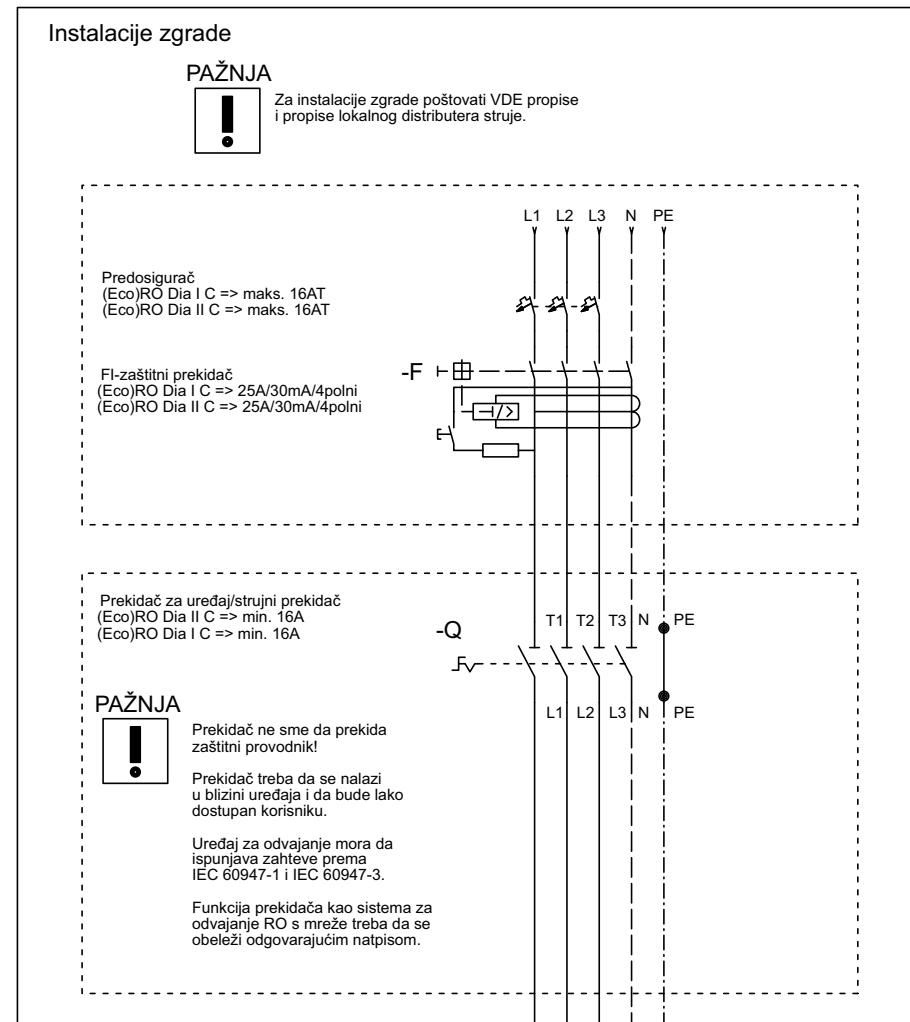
Plan postavljanja (Eco)RO Dia II C
